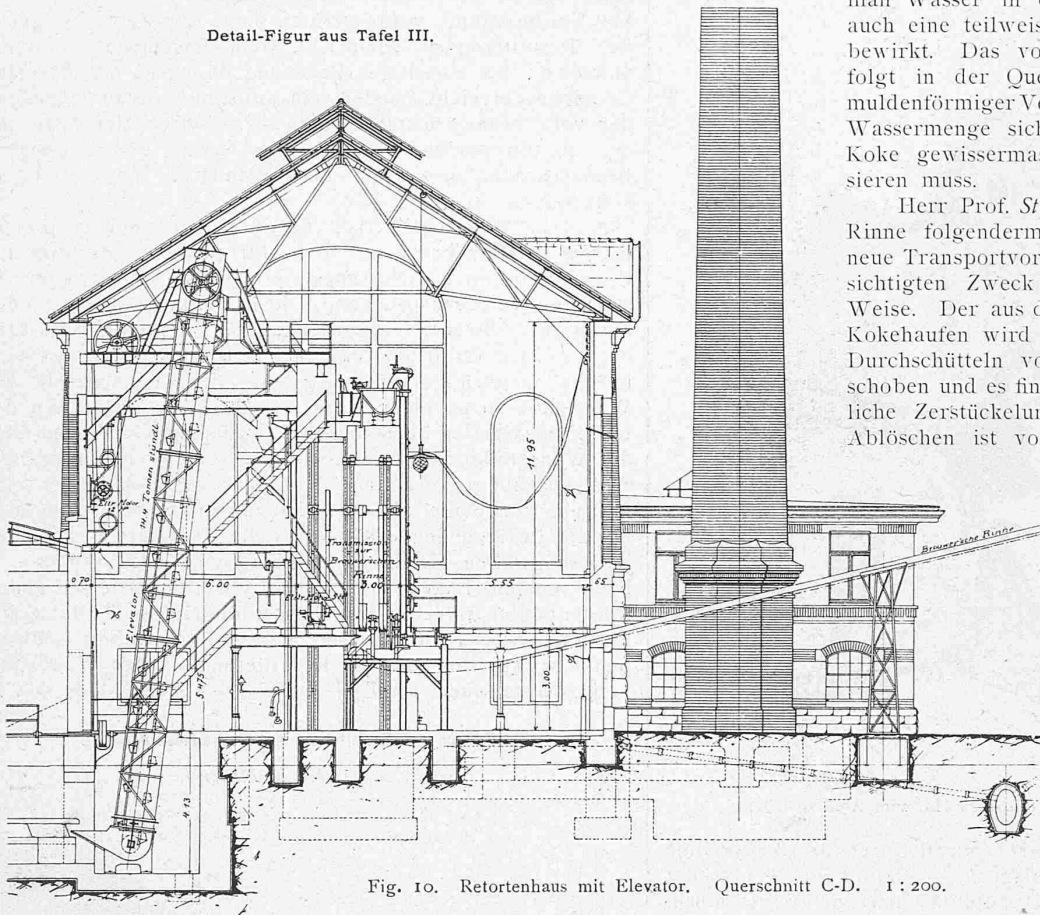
Retortenhaus mit Elevator. Querschnitt C-D. 1:200.
